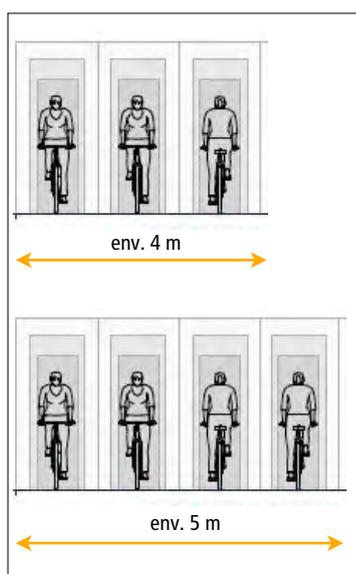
Largeur d'une piste cyclable bidirectionnelle dans différentes situations (dépassements, croisements)
